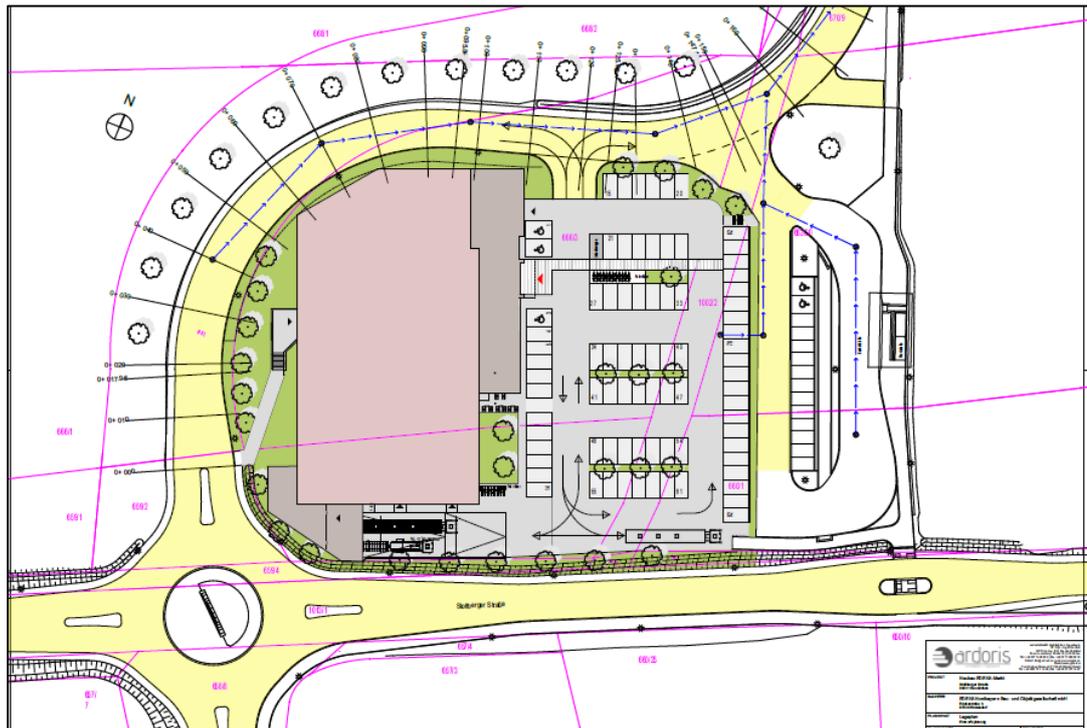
Lageplan des Vorhabens an der Stollberger Straße<sup>27</sup>
